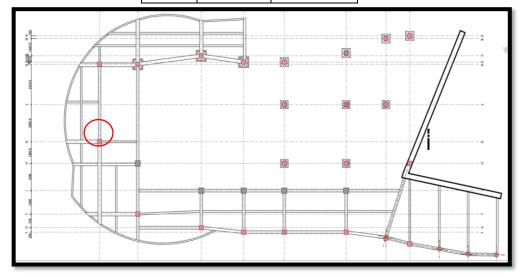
Ubicación de columnas planta baja y columna más esforzada
